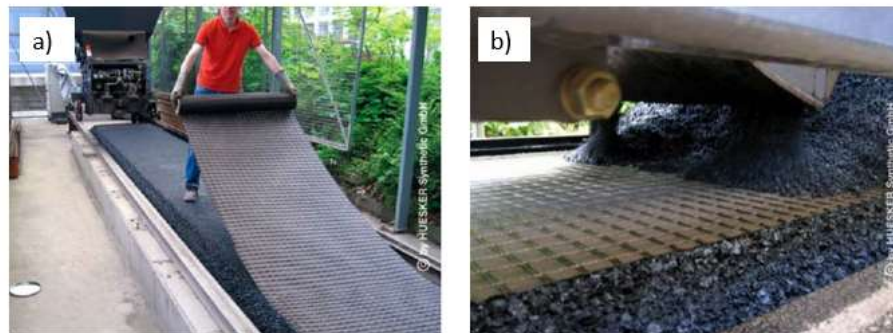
Detalhes da construção da seção teste: a) instalação da geogrelha para reforço do pavimento; b) aplicação da camada superficial. Fonte: Huesker (2008).
